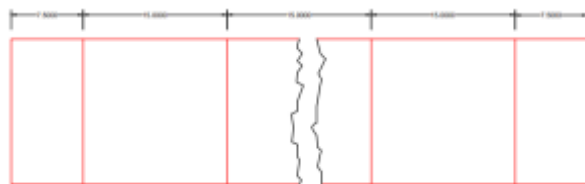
Sketsa Pola Retak Balok Beton Normal 1
